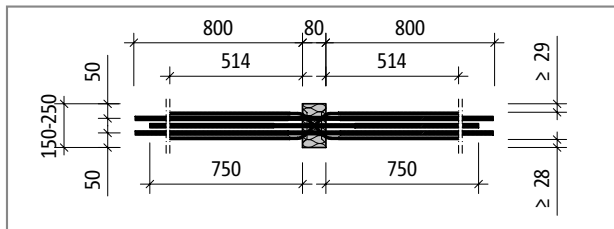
Schöck Isokorb® tipo W30L: pianta del prodotto
